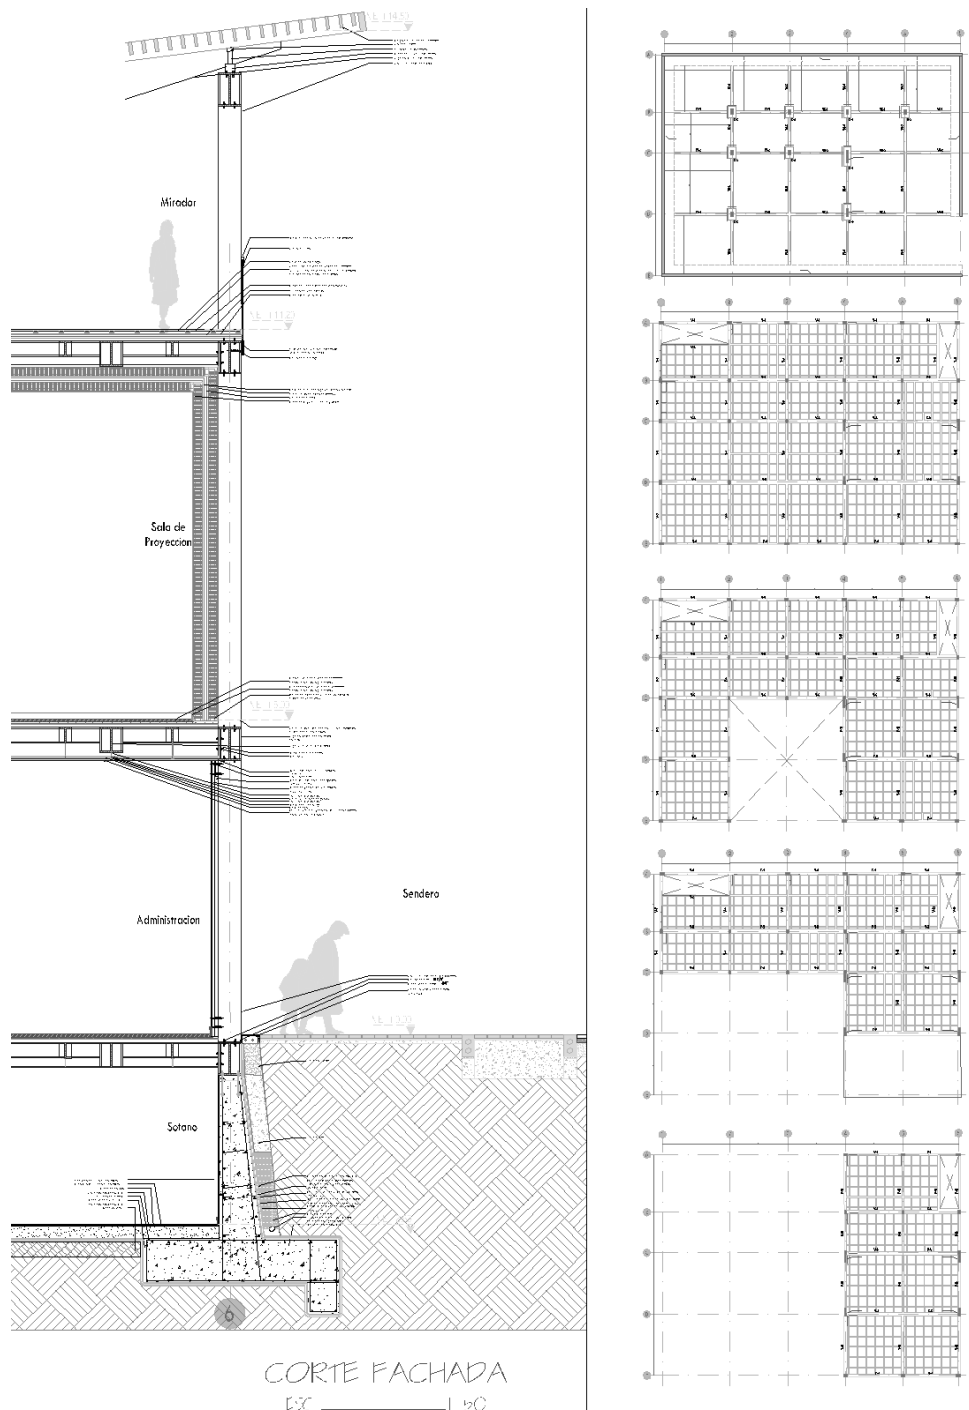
Corte fachada y plantas estructurales Ludoteca el Vergel
